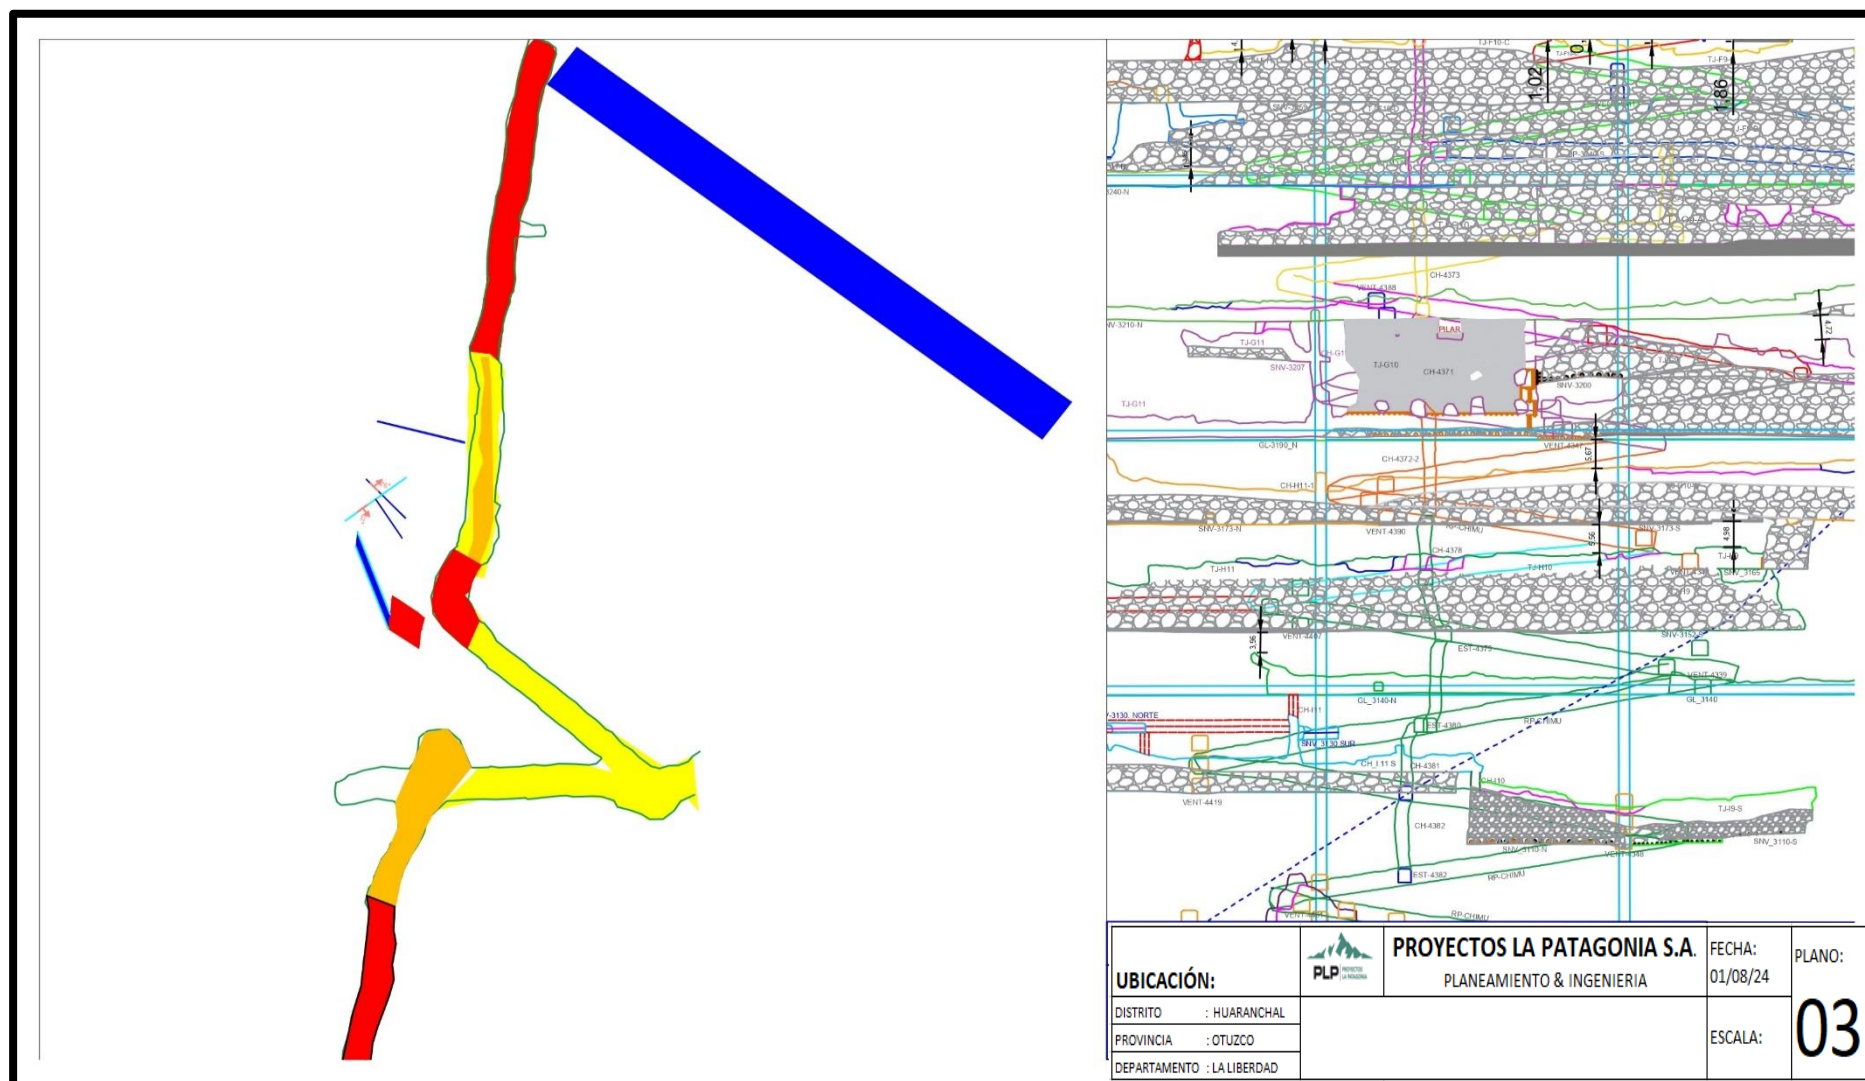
Plano geomecánico con dirección al sondaje de la galería 4139N.
